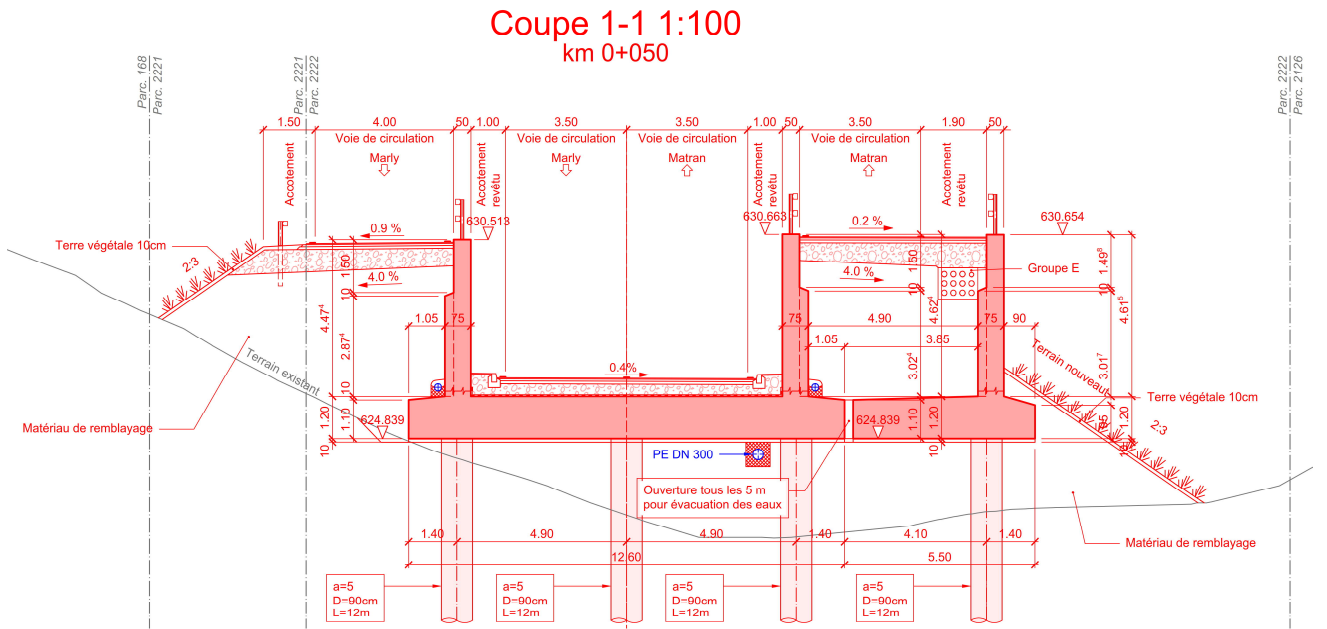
Coupe transversale de la trémie du PI Crausa avec son mur de soutènement adjacent, km 0+050
